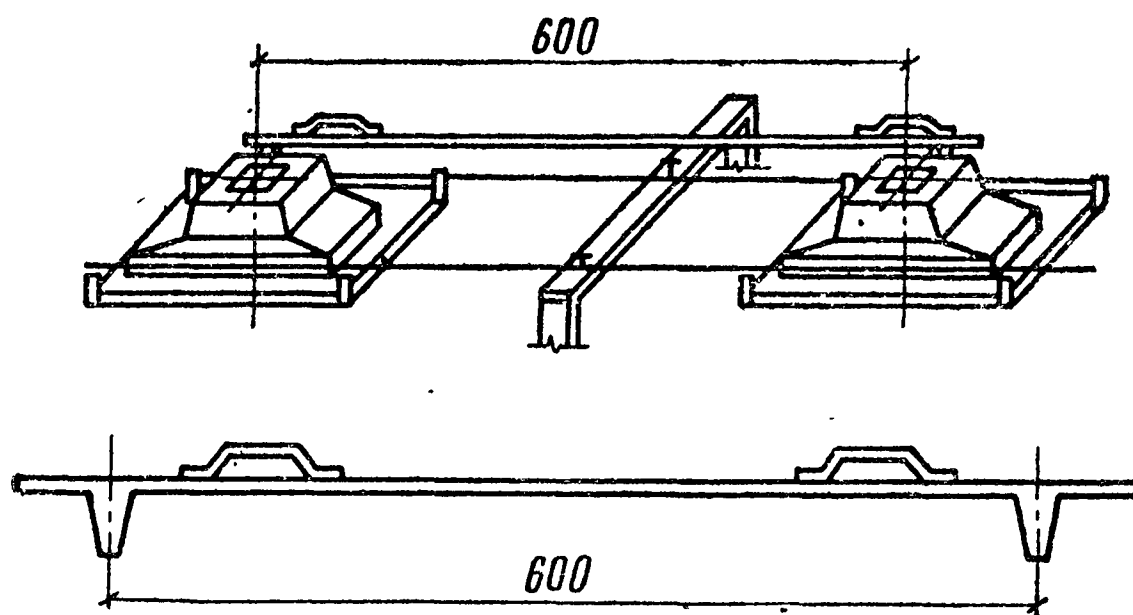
Шаблон для проверки расстояния между фундаментами
